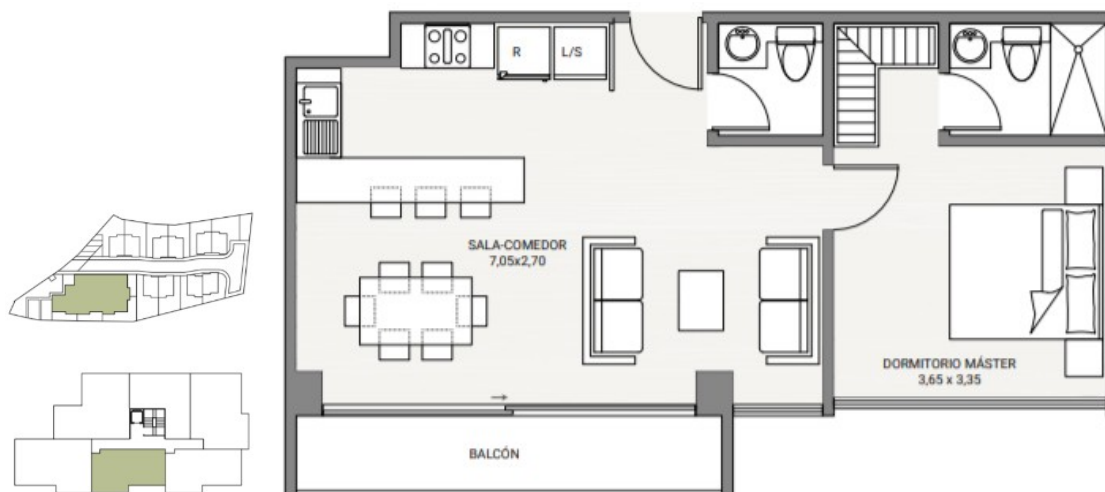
Planta tipo suite de un dormitorio en segunda y tercera planta
